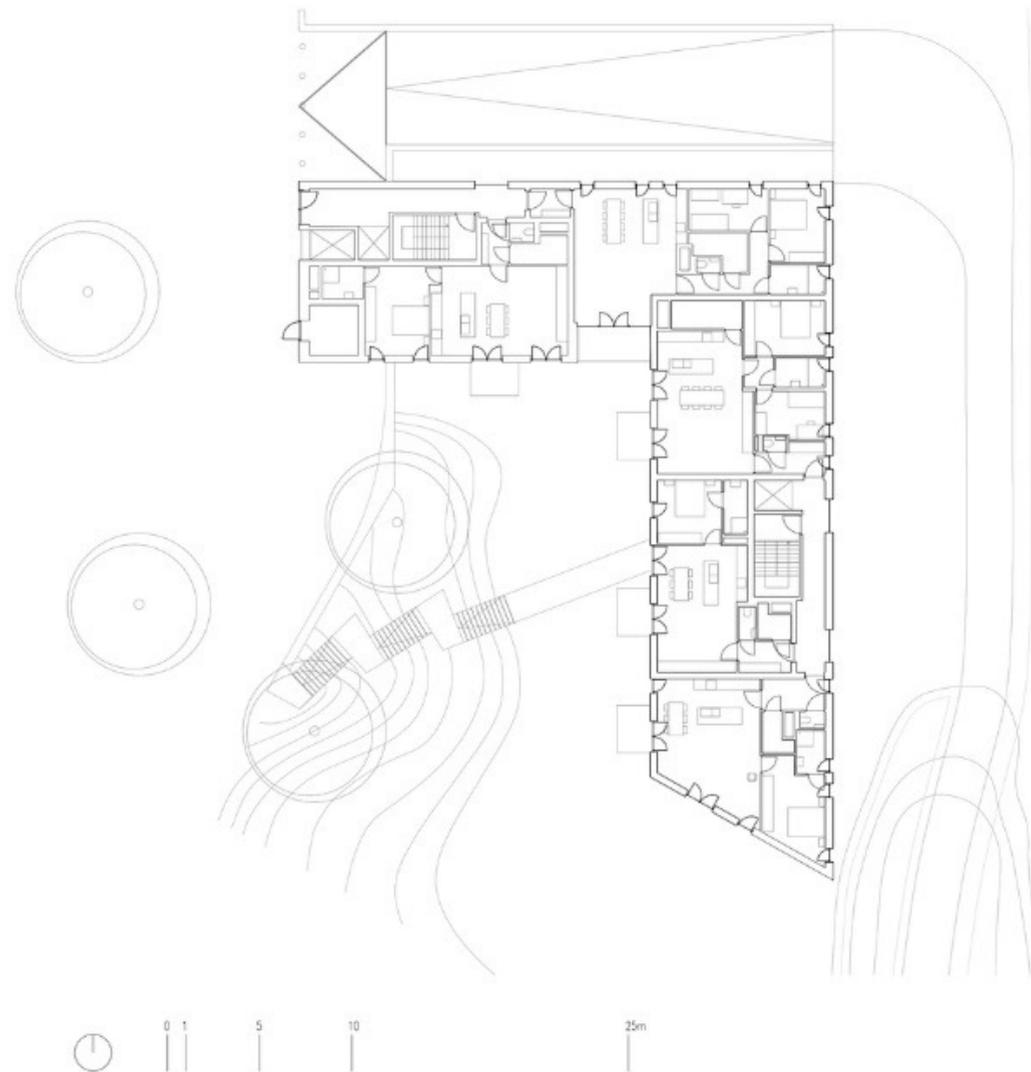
Plantas del proyecto de vivienda social Klein Rijssel.
